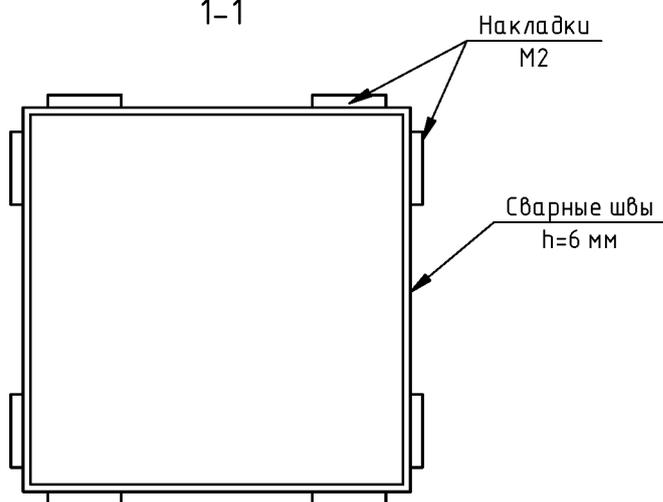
Схема сварки секций свай третьего типа армирования
